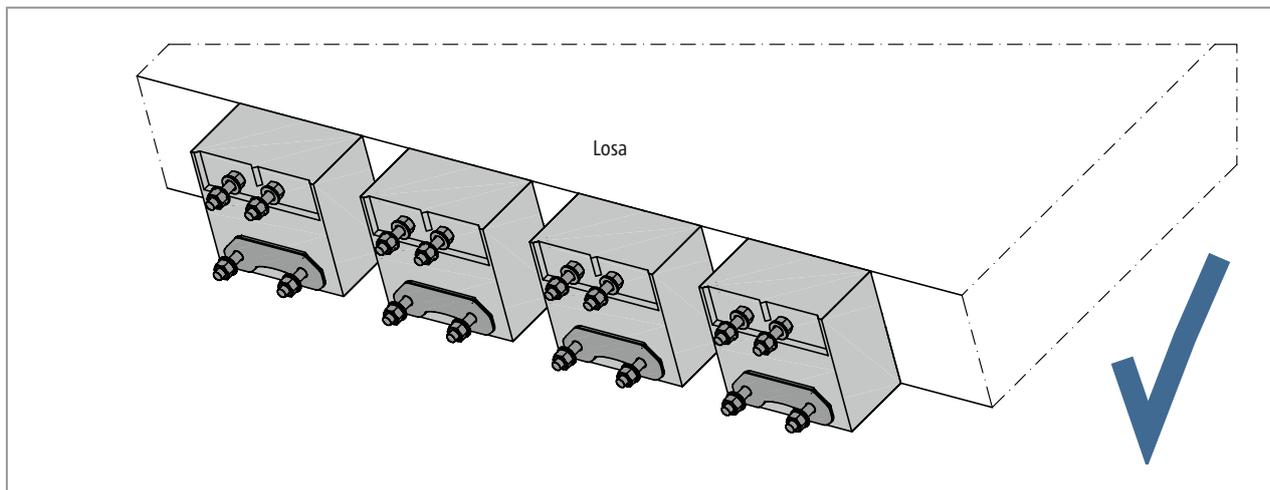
Schöck Isokorb®: Una buena fijación del elemento durante el hormigonado permite lograr la precisión de instalación necesaria
